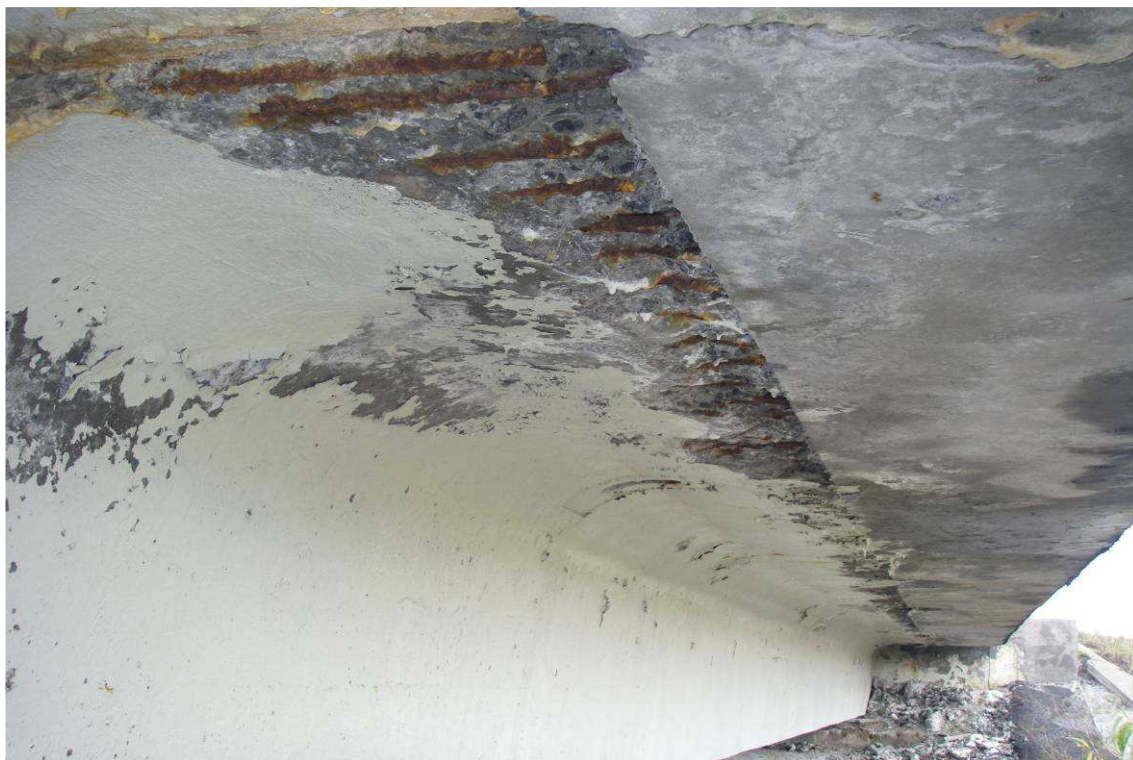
Пролетное строение №5, балка №7. Разрушение защитного слоя бетона консоли балки пролетного строения с оголением арматуры и ее коррозией
